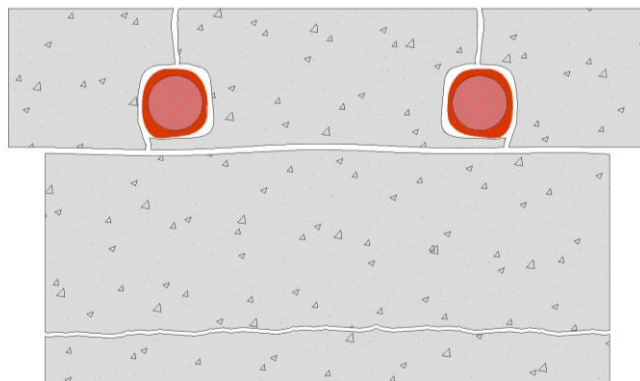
Corte esquemático do recobrimento existente no muro após corrosão das armaduras
